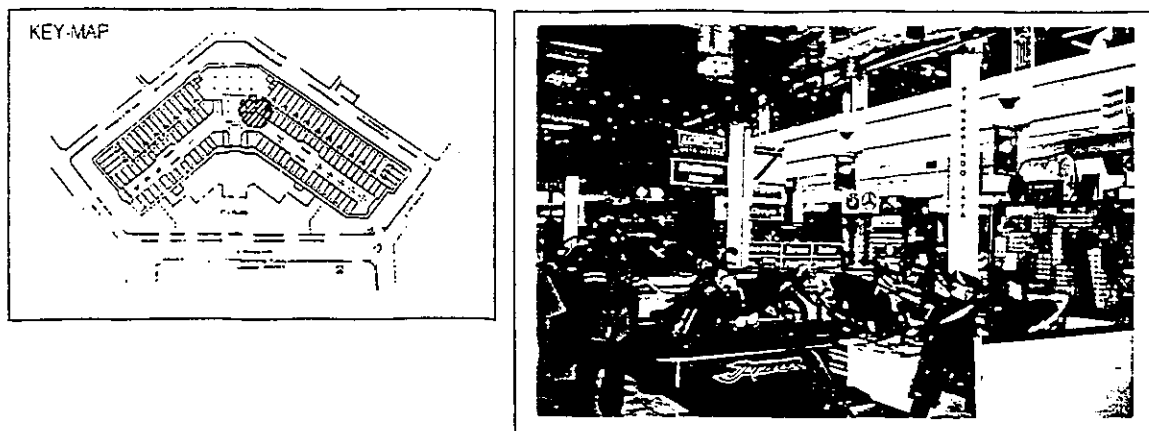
Perletakan Ruang Berderet Secara Linear
